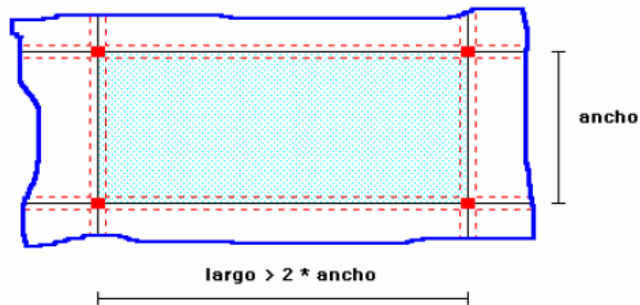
Losa unidireccional apoyada sobre cuatro vigas.
